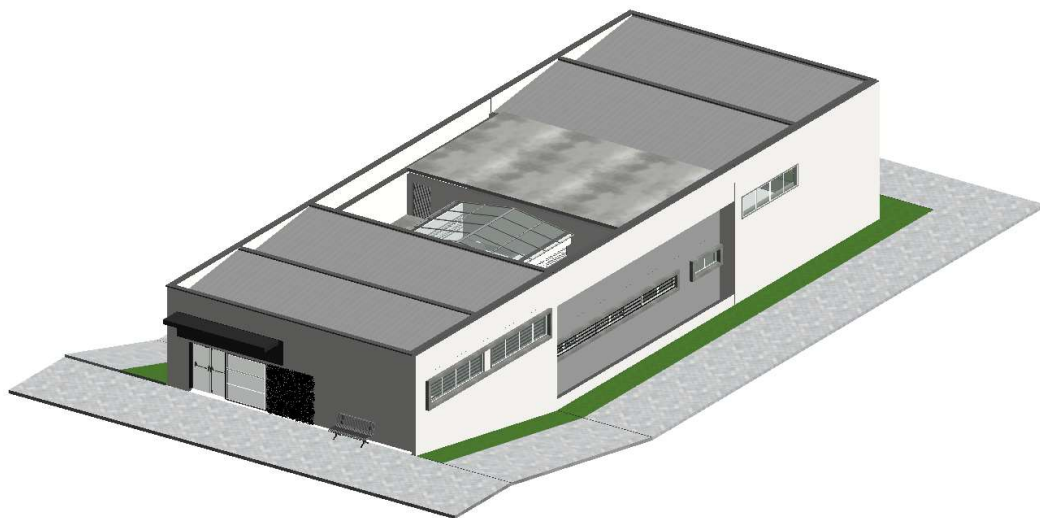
Modelagem arquitetônica: Elevações 1 e 4 do projeto original
